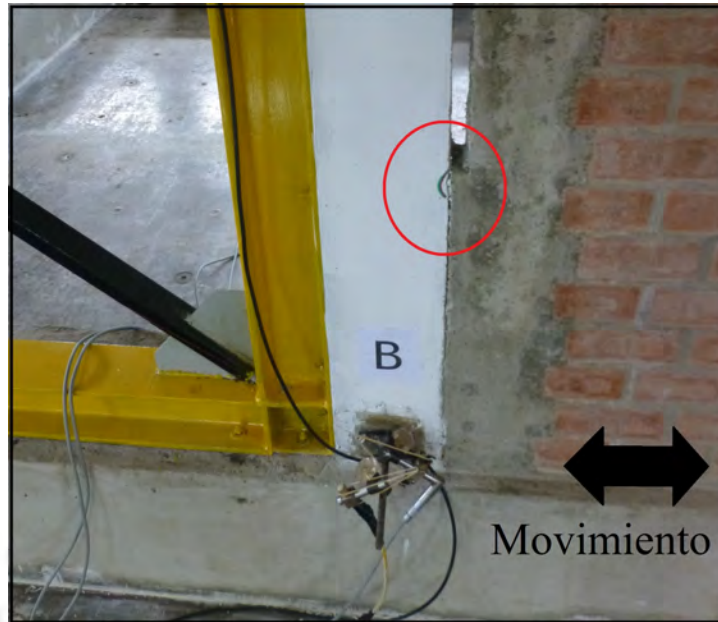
Post Fase 4, daño observado en la columna central C - 2 del primer piso
